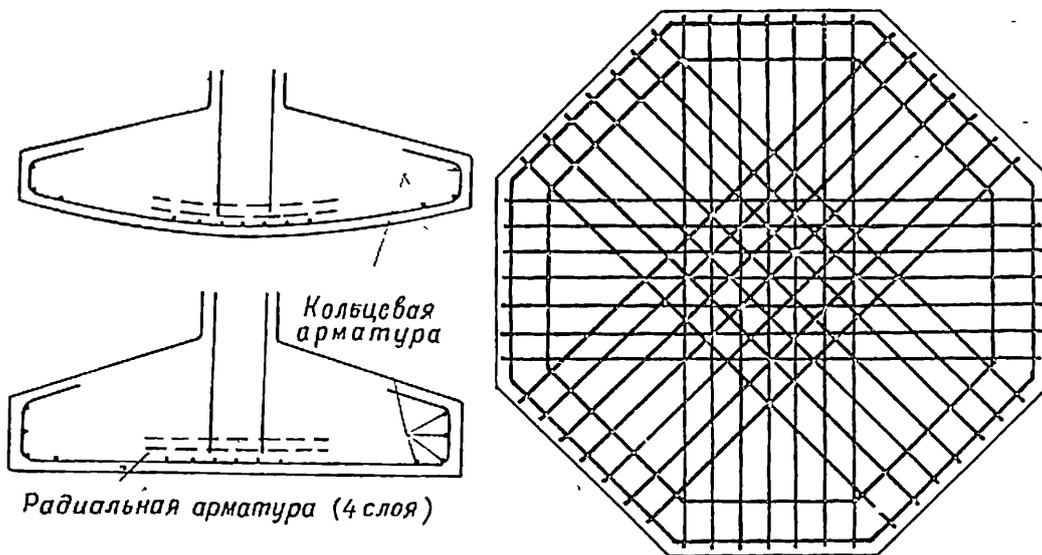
10. Восьмиугольный фундамент для больших нагрузок с кольцевой арматурой
